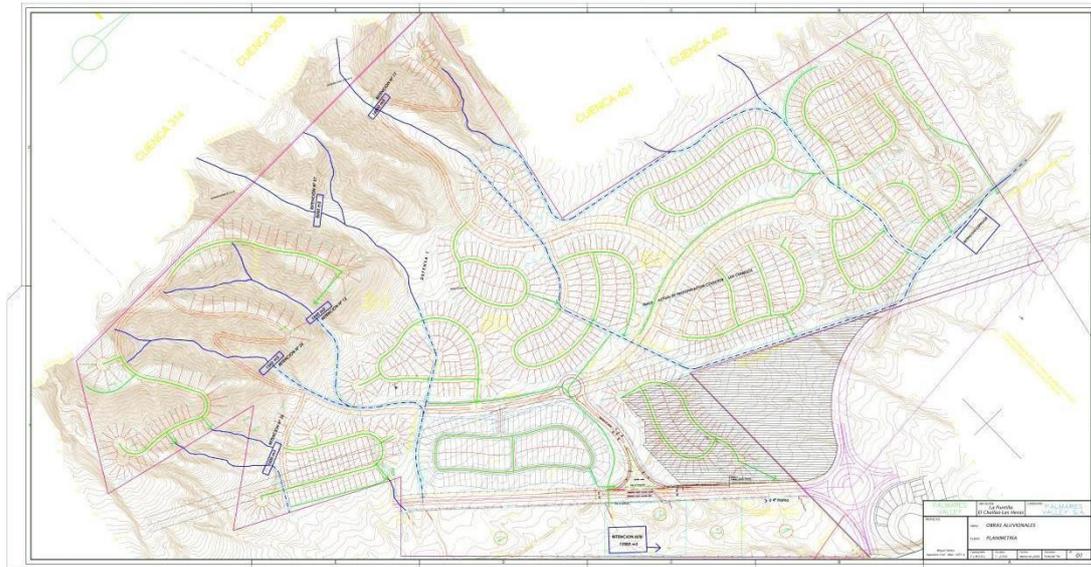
Croquis de Obra de Master Plan proyectado y ejecutado en la urbanización Palmares
